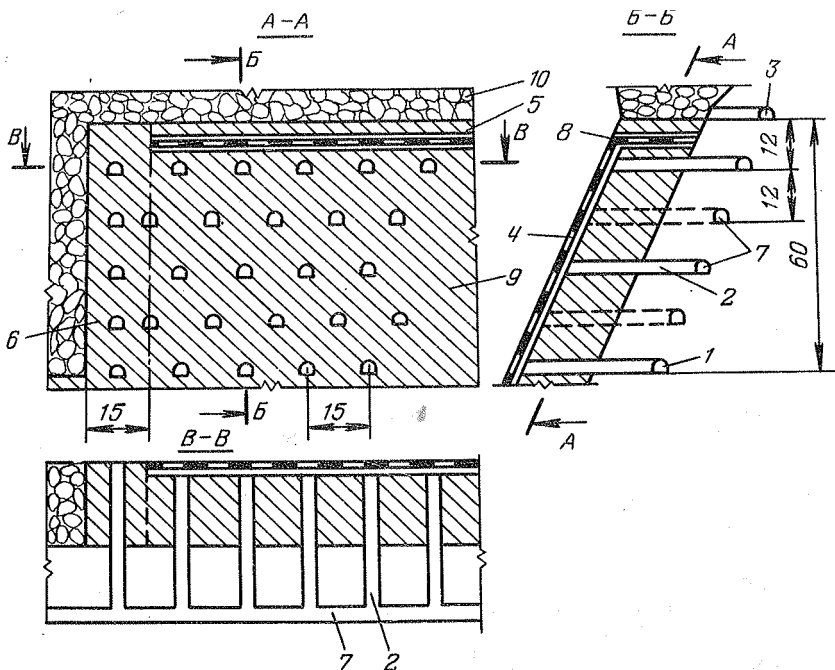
"Шведский" вариант системы с подэтажным обрушением, в котором используется разделяющее гибкое перекрытие:
